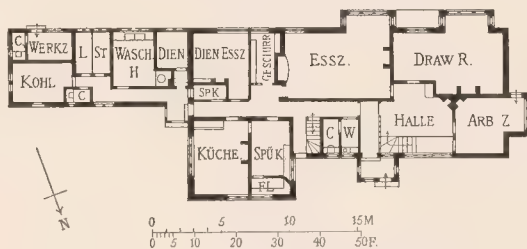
Haus Belgaum in Woking, Surrey. Erdgeschoß. Erbaut von Walter Cave. 1:400.
